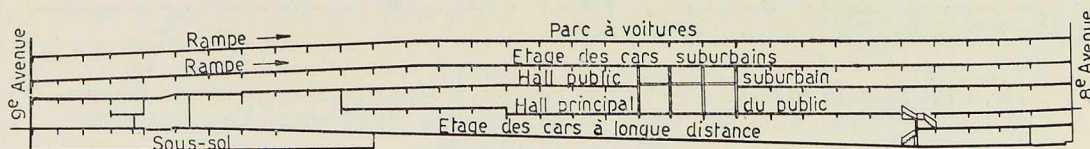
Coupe longitudinale de la gare d'autobus de New-York.
